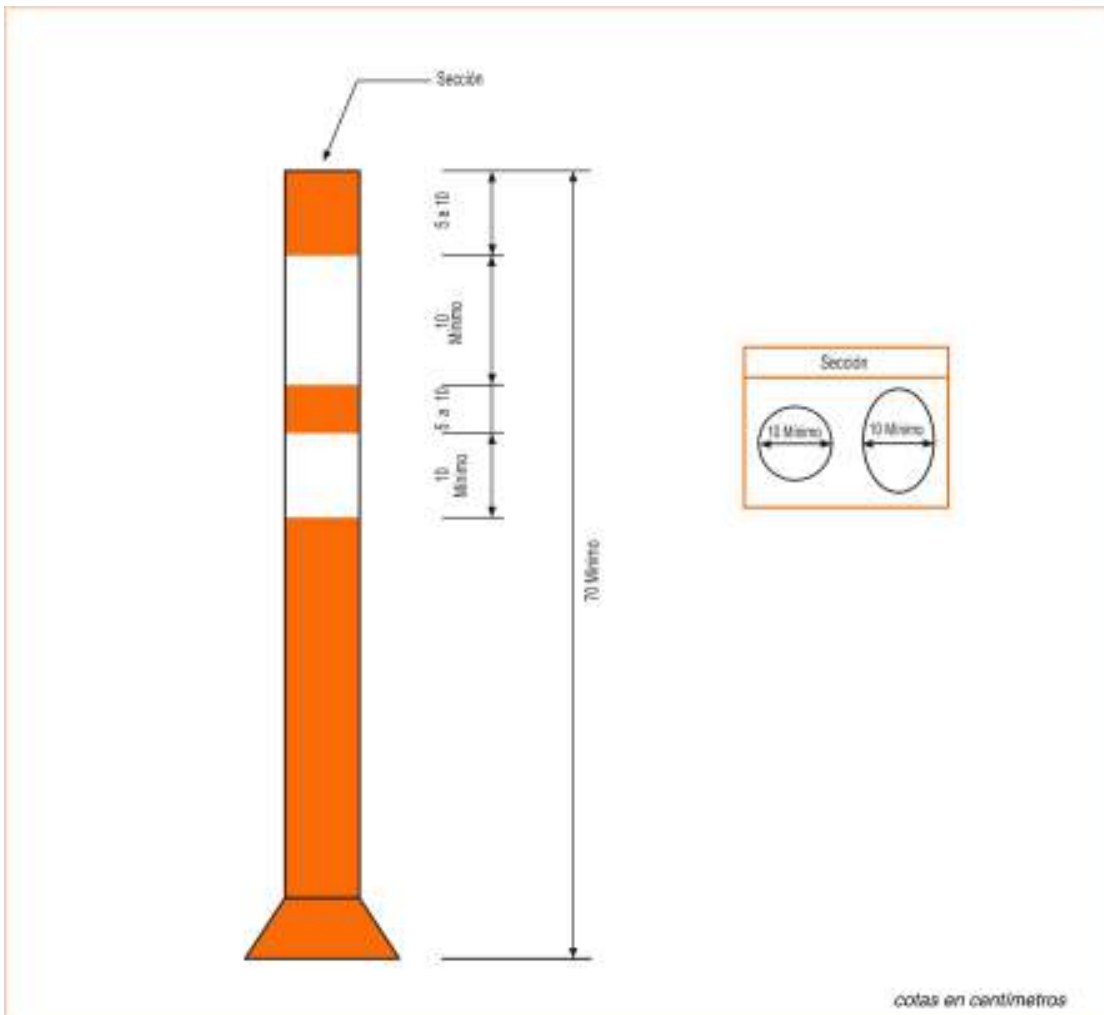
CILINDRO DE TRÁNSITO
